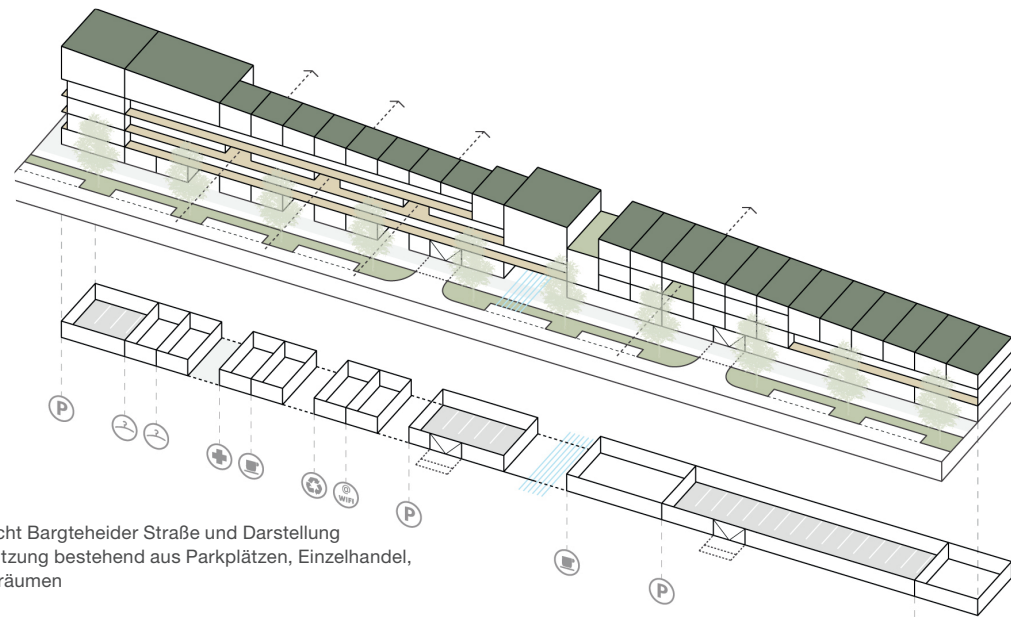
Isometrie: Ansicht Bargtheider Straße und Darstellung Erdgeschossnutzung bestehend aus Parkplätzen, Einzelhandel, Gemeinschaftsräumen
